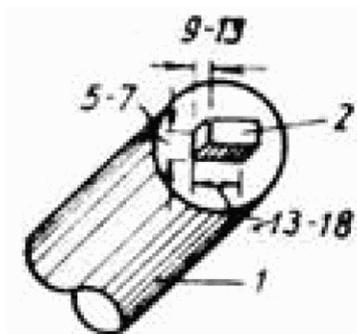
Шип для насадки нижнего венца или обвязки:
